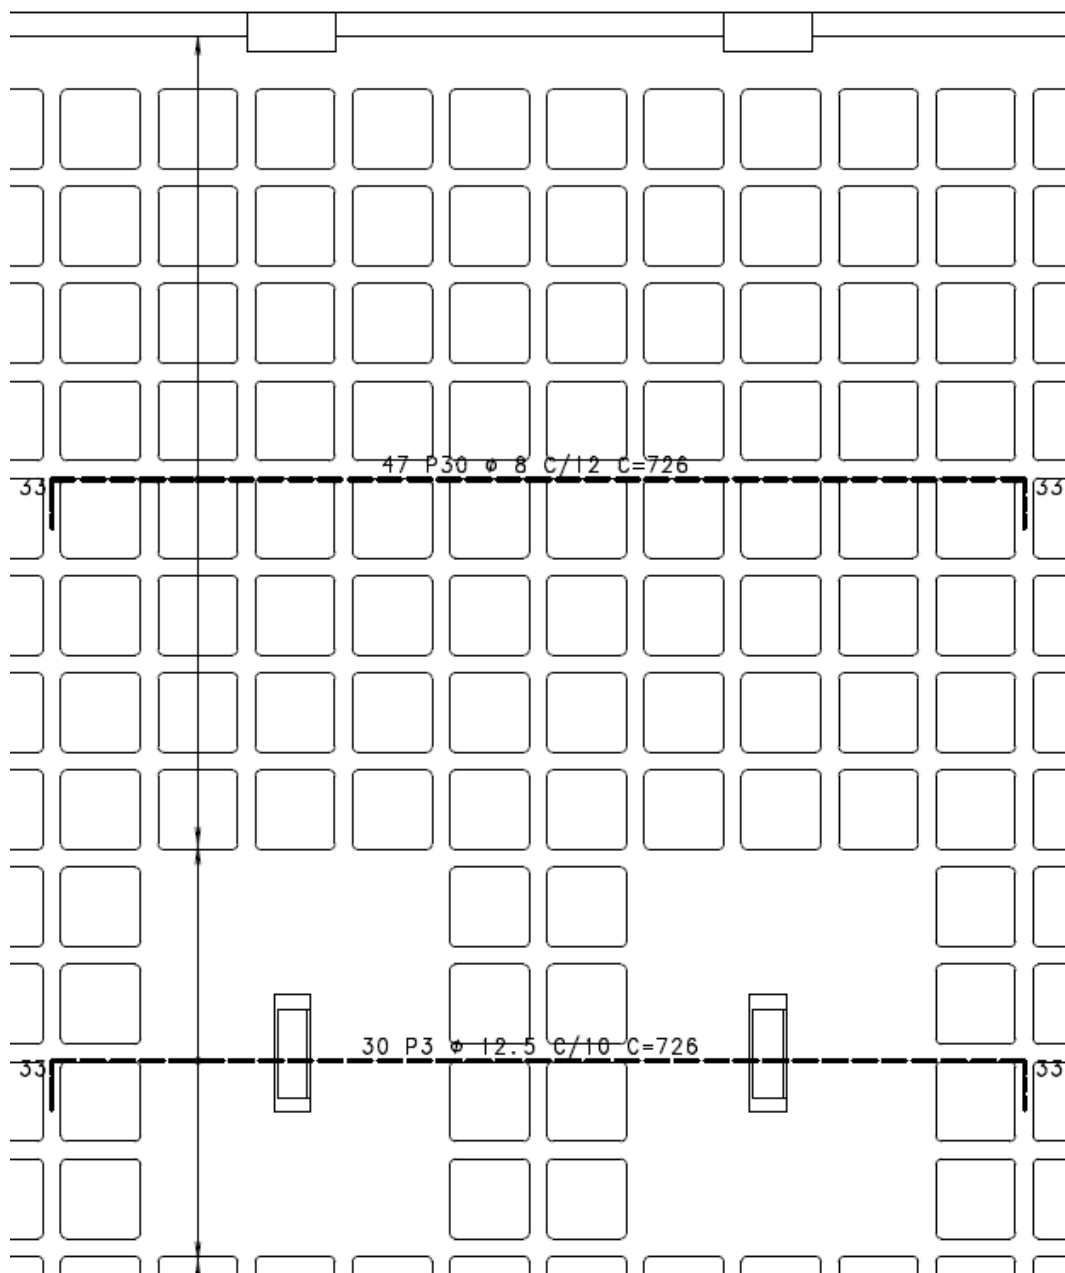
11 – Detalhe das armações negativas horizontais do primeiro pavimento.
